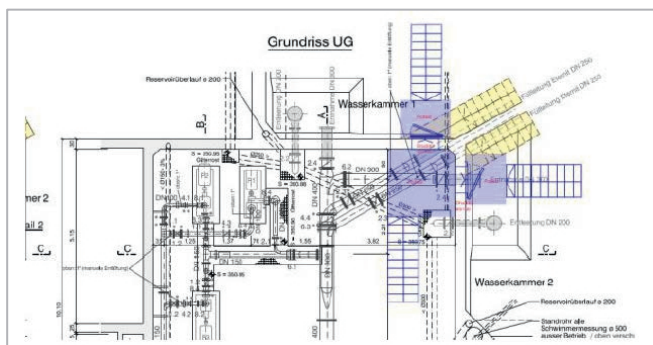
Grundriss Rohrkeller mit Drucktüren und Podest
